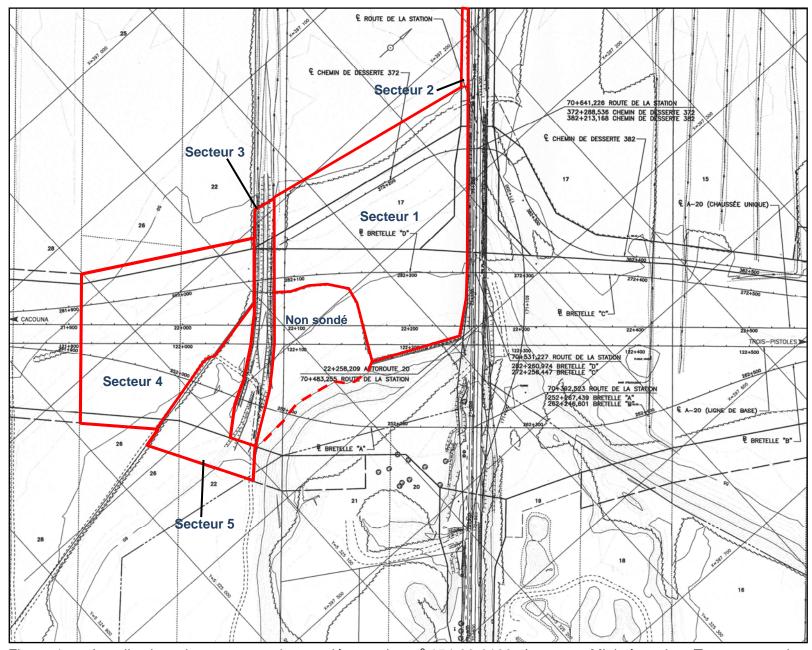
Localisation des secteurs inventoriés, projet nº 154-90-0100 (source : Ministère des Transports, plan d'ensemble [extrait], État des lieux – Autoroute 20 -21+900 à 22+500 et Route de la Station, plan CH-6508-154-90-0100-4, 5/16, 20 mars 2010)
